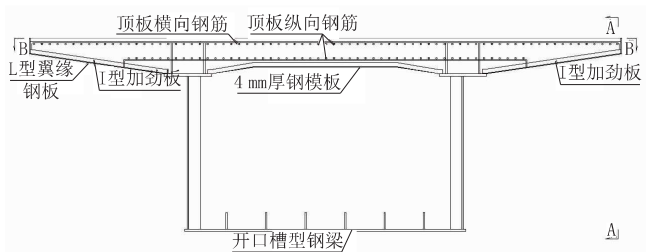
新型钢-混凝土组合桥梁纵向剖视示意图
